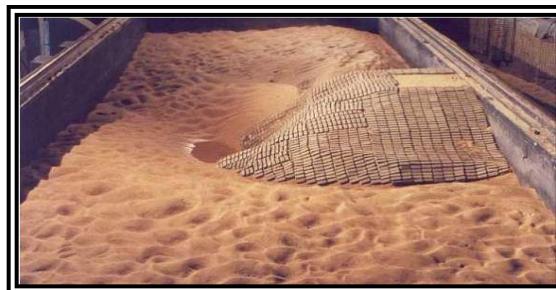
Modelo físico a fondo móvil – Estribo protegido con bloques de hormigón adheridos a geotextil¹¹⁷.
